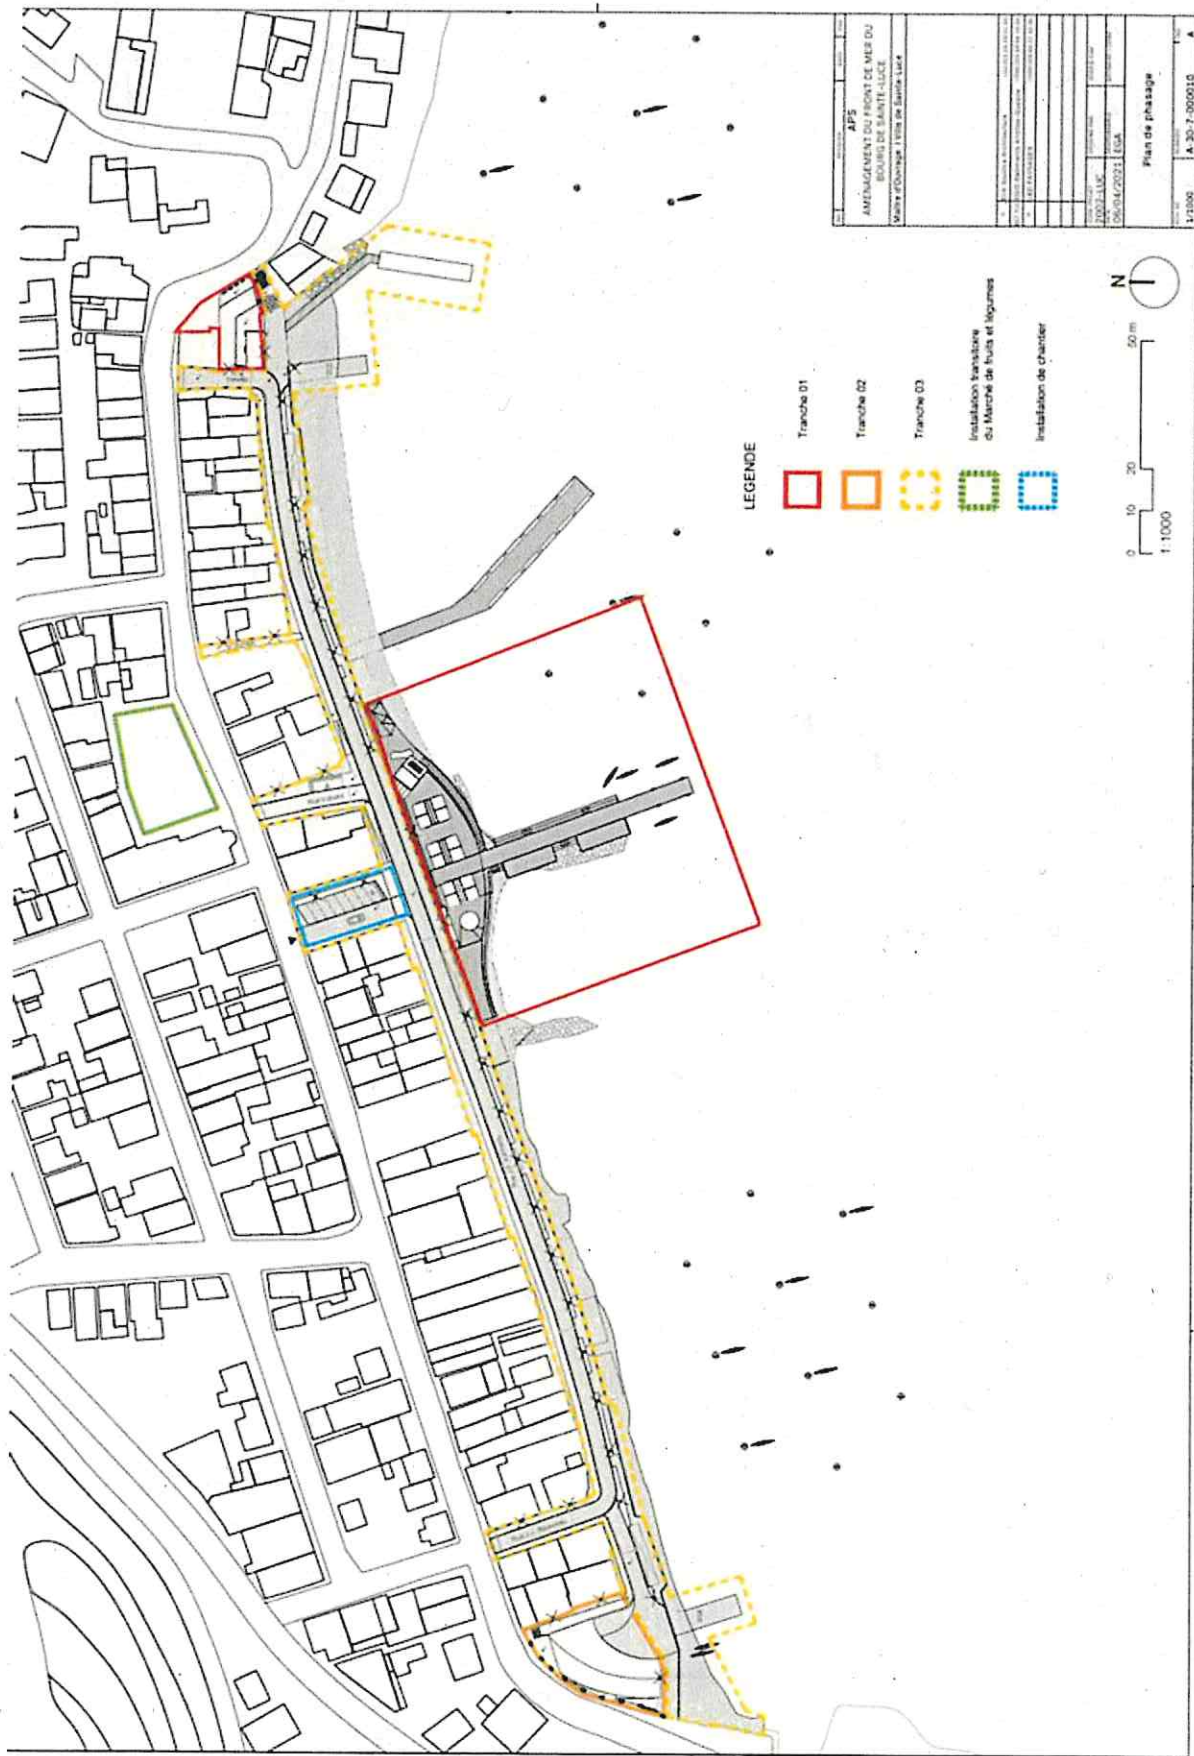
PLAN DE PHASAGE DES TRAVAUX
